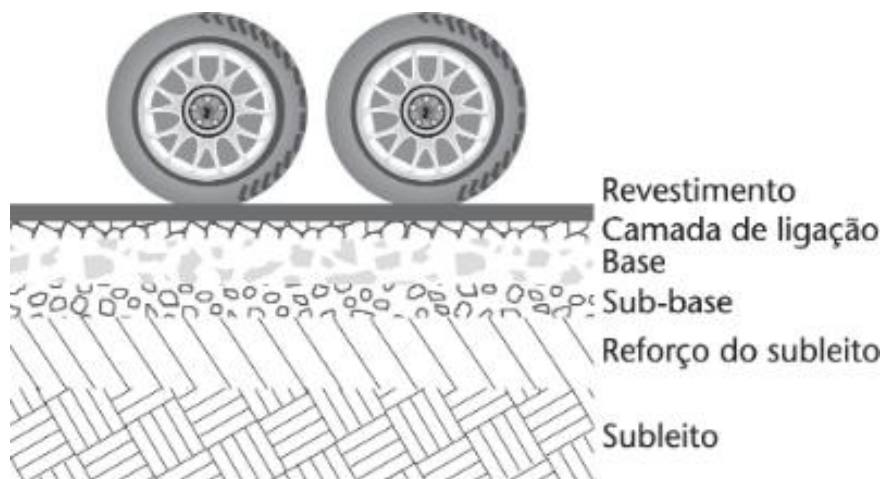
Estrutura genérica de um pavimento. Fonte: Balbo (2007).
